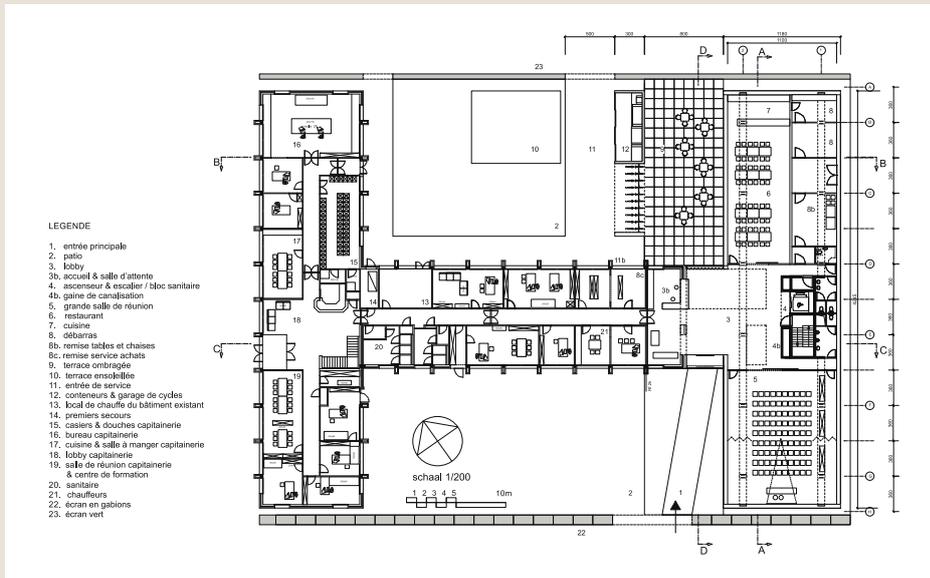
Siège du 'Havenbedrijf Gent' - Plan du rez-de-chaussée (à gauche, le bâtiment existant ; à droite, l'extension)
